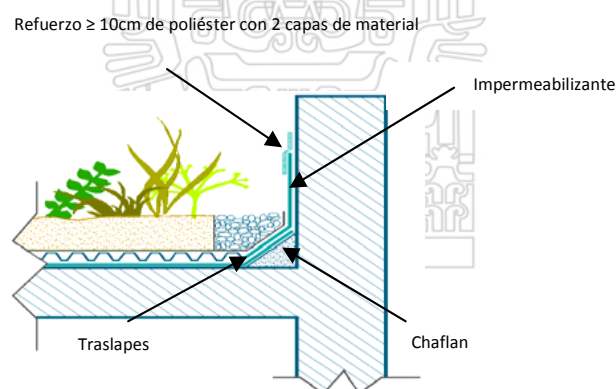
Impermeabilización con membrana prefabricada asfáltica en puntos de encuentro con pretilas elementos emergentes perimetrales.
